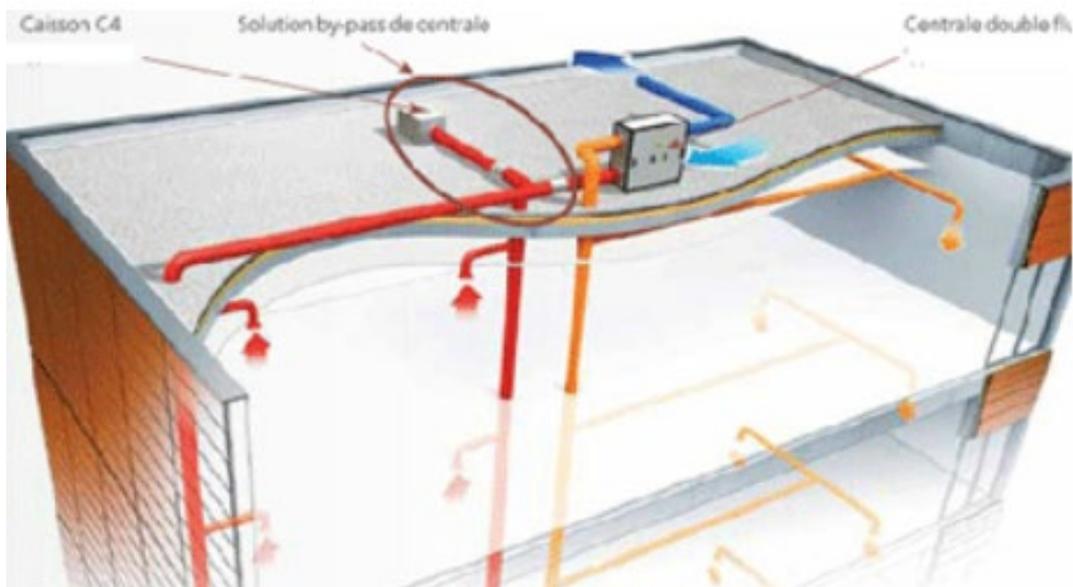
Sistema di distribuzione e ventilazione aria. Fonte: ICF Sablier locatment
